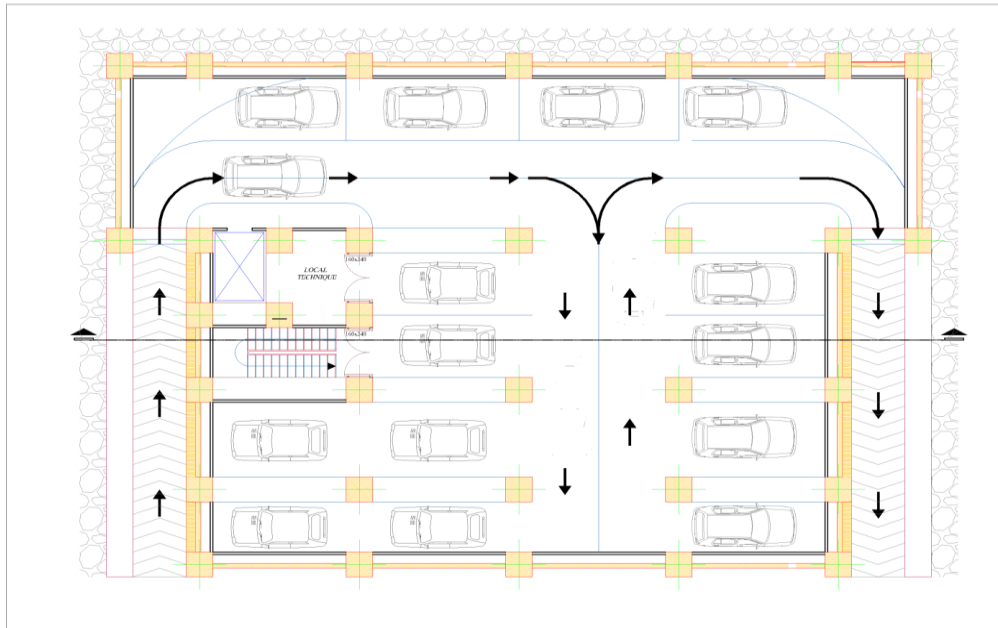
Vue en plan de sous-sol échelle 1/50.
